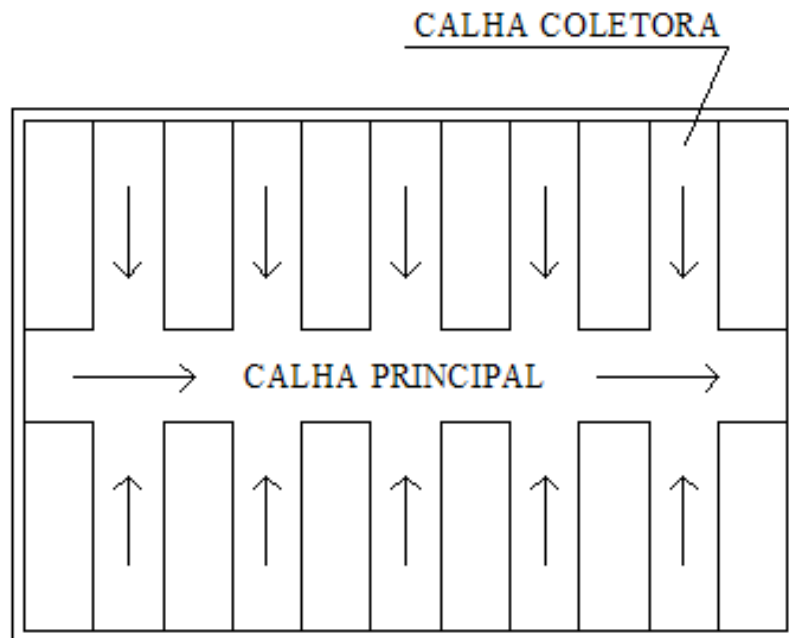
planta baixa de um sistema de calhas coletoras desaguando em calha central
